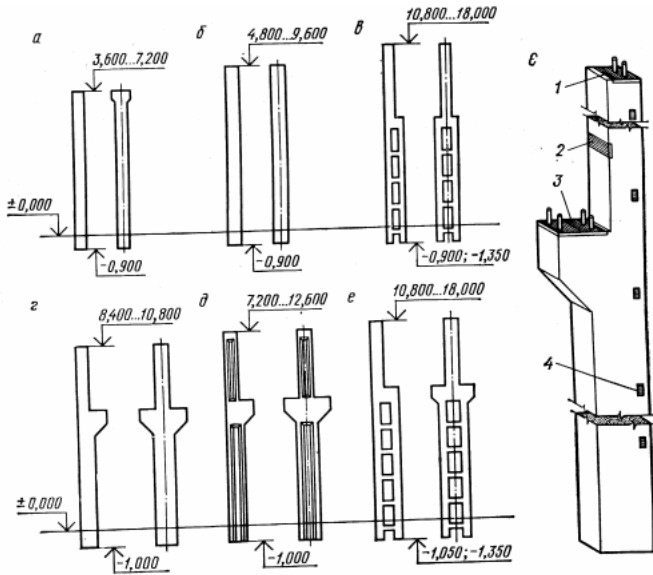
Основні типи залізобетонних колон одноповерхових промислових будівель:
